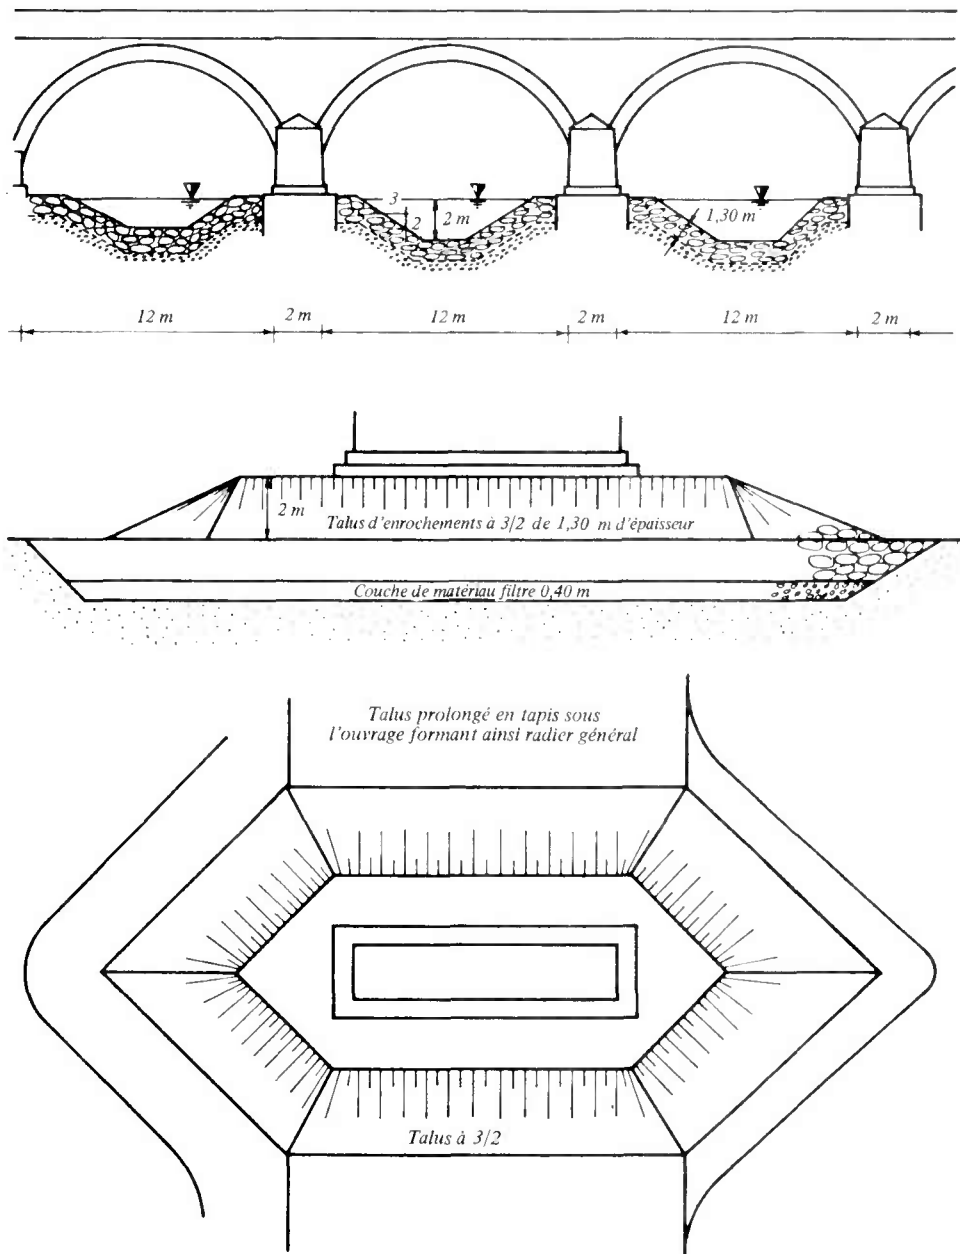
Protection d'un ouvrage ancien par talus d'enrochements.
